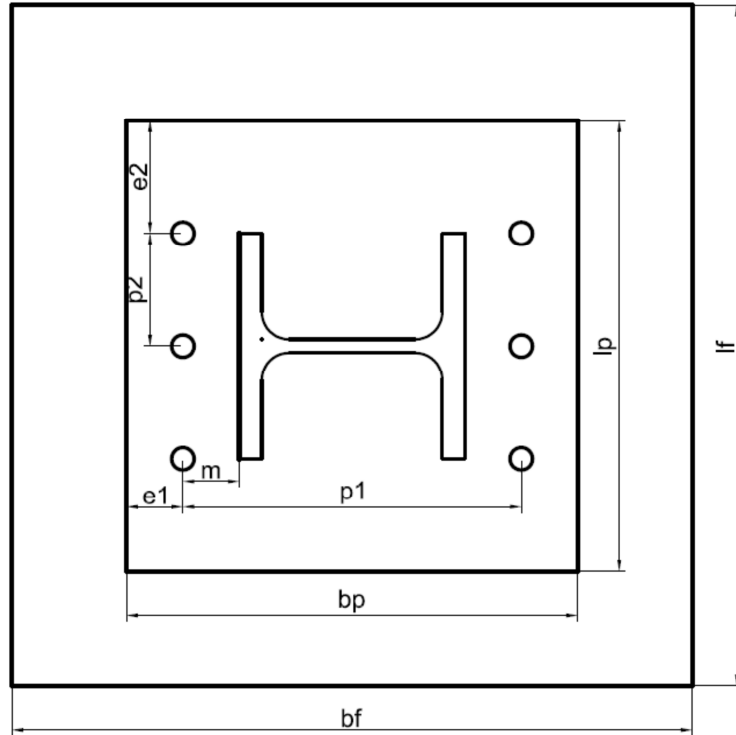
Parametrização da planta de uma ligação de uma base de um pilar metálico
